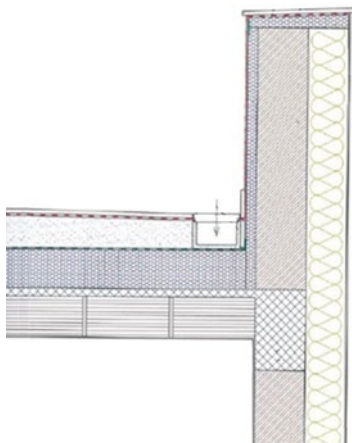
Stratigrafia di solaio in latero-cemento, coibentazione in lastre di XPS, telo di protezione, massetto di pendenza, guaina liquida, collante e pavimentazione in gres. Fonte: [60]
